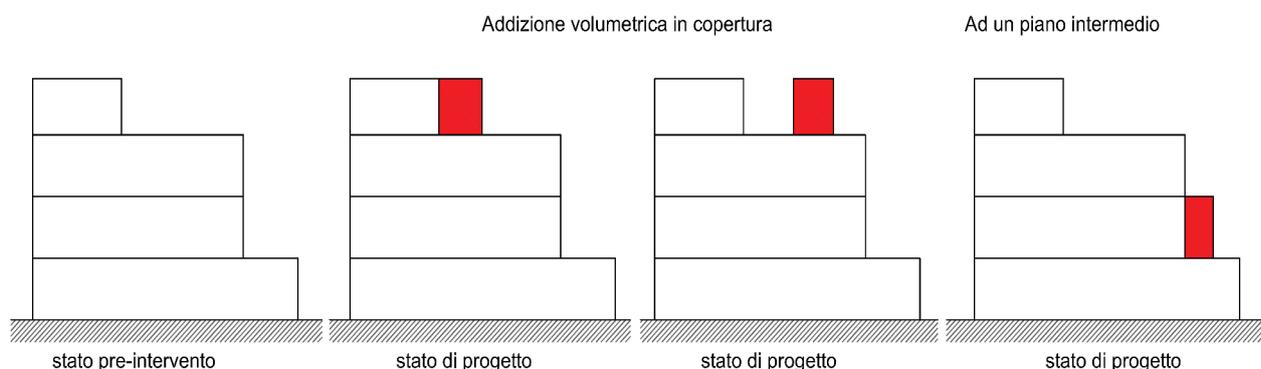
Esempio di addizione volumetrica in copertura o a piano intermedio.
